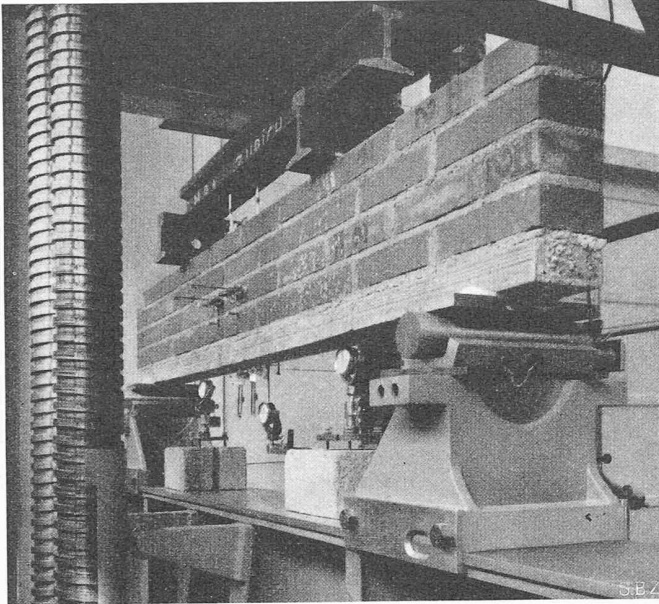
Belastungsversuch an einem vorgespannten Stahltonbrett mit Uebermauerung
